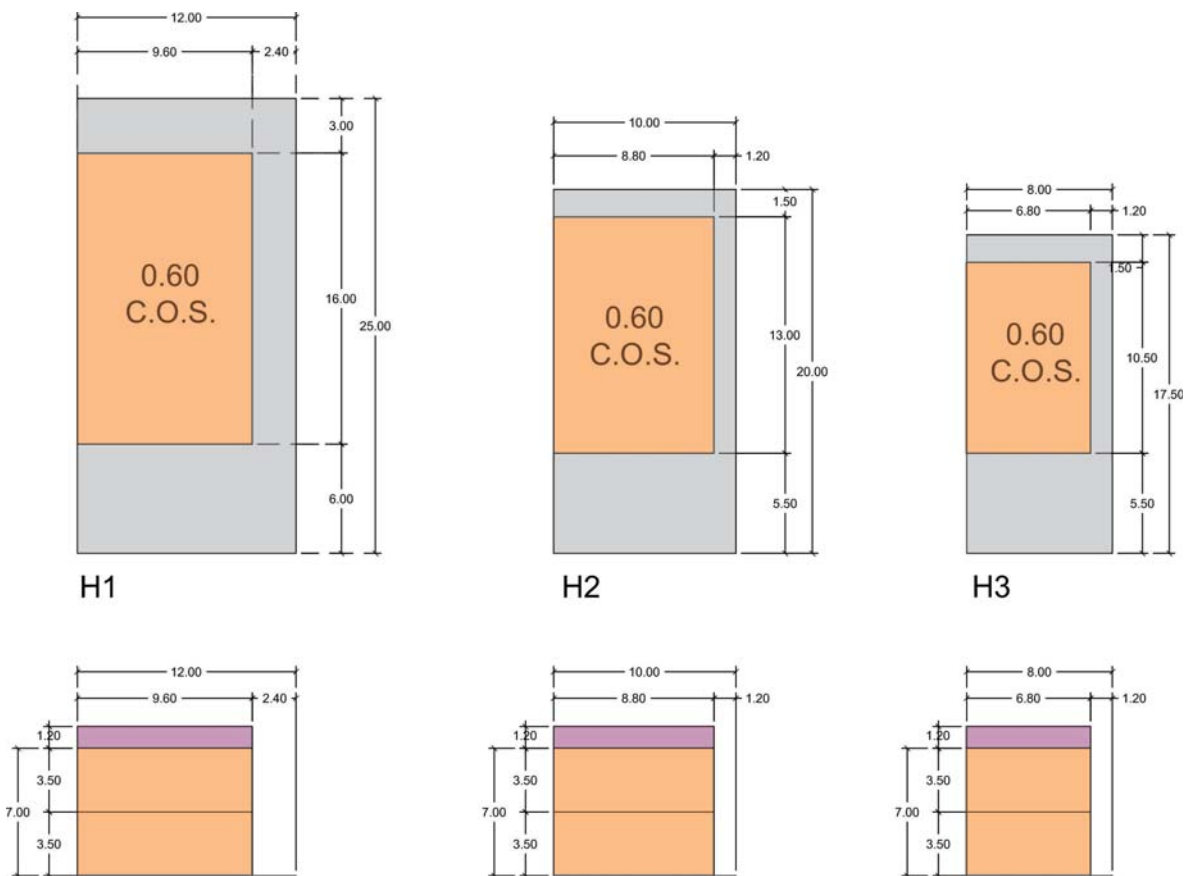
Esquemas en planta y sección de Vivienda unifamiliar
